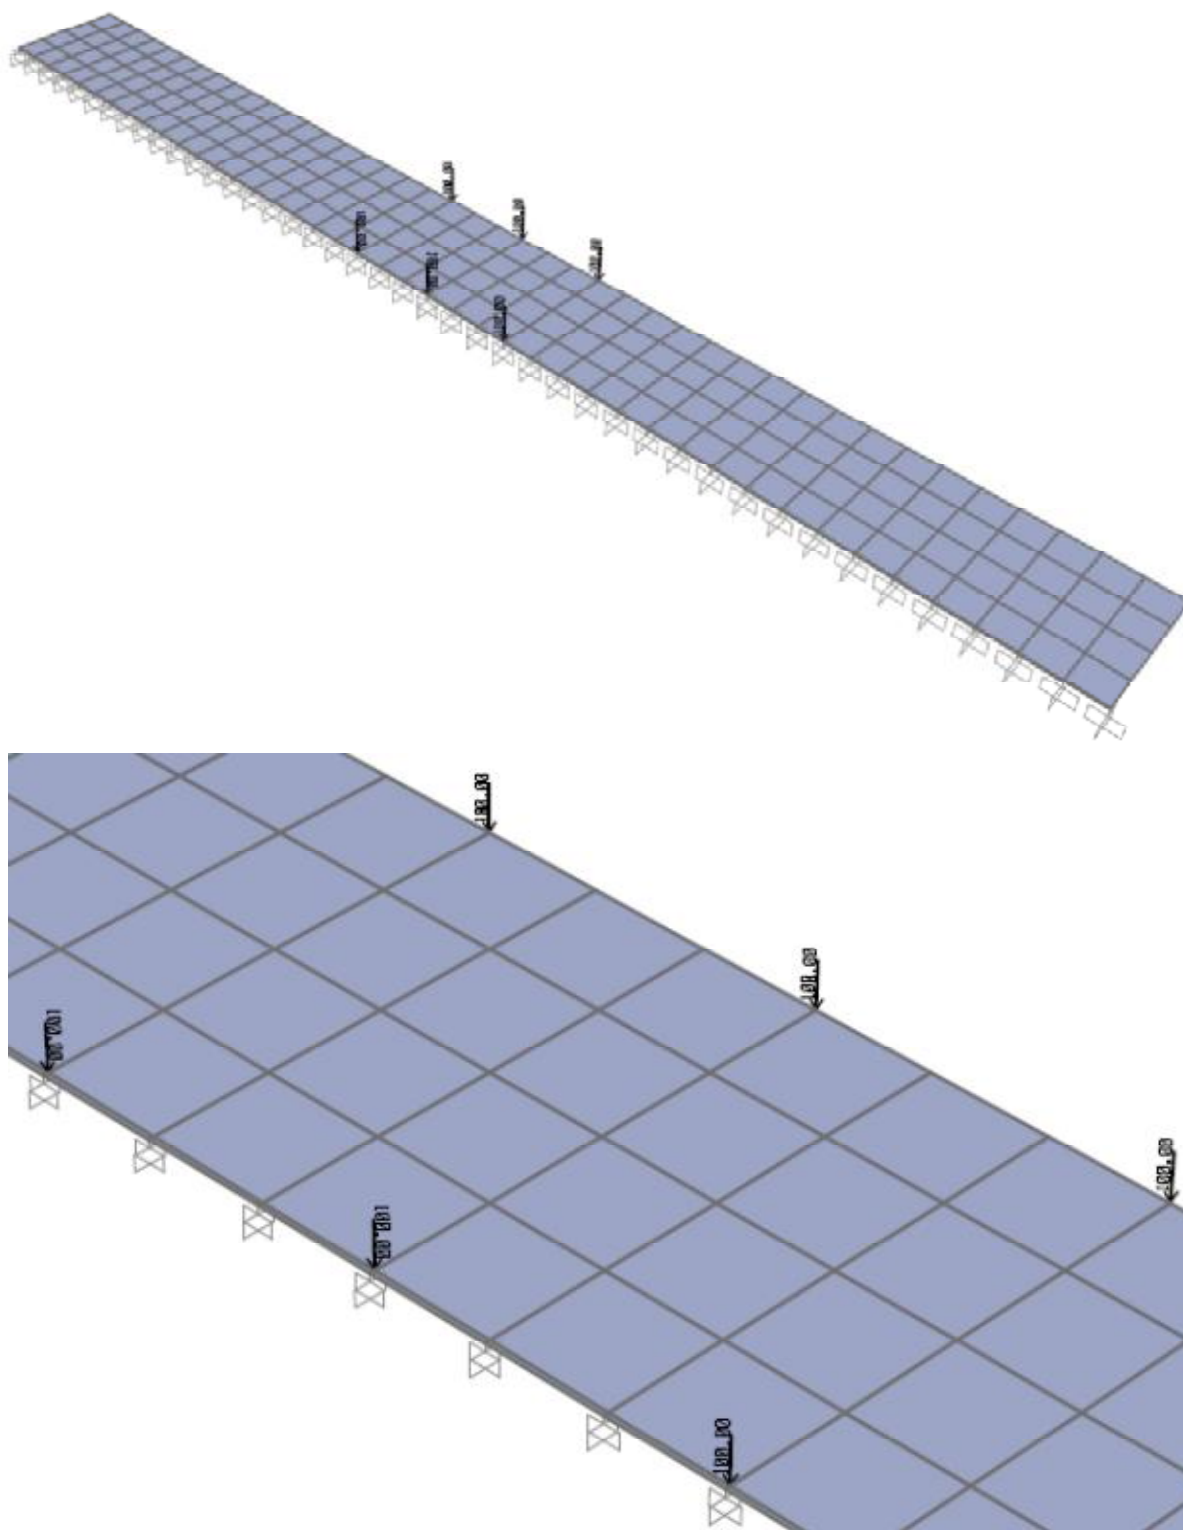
Modelo estrutural (vista geral e pormenor) das consolas do tabuleiro – análise do Veículo Tipo
